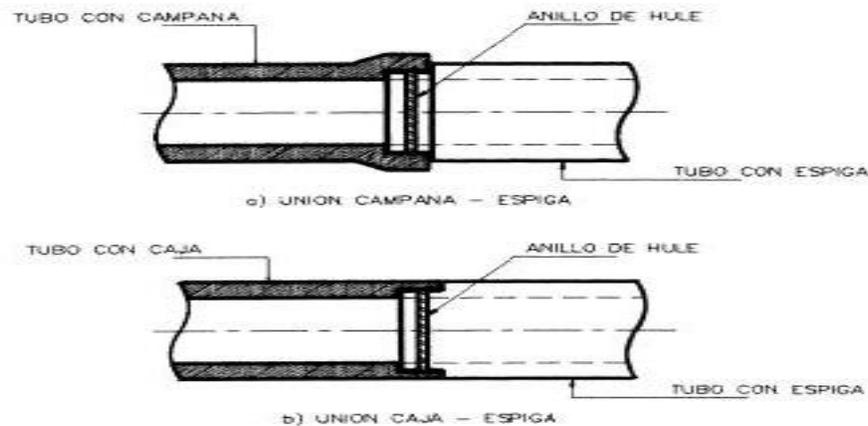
Tipos de uniones en tuberías de concreto.
